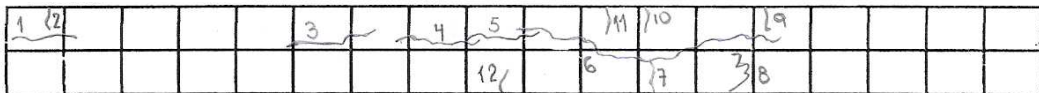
Fisuras observadas en la viga 1.
